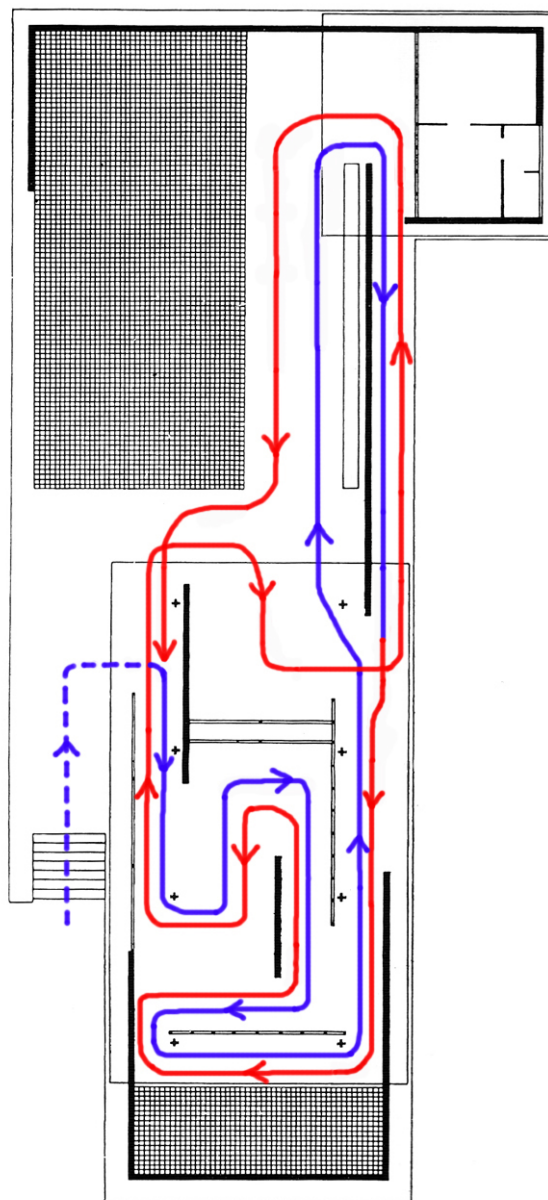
Planta del Pabellón de Barcelona. Recorridos de ida (en azul) y vuelta (en rojo).
